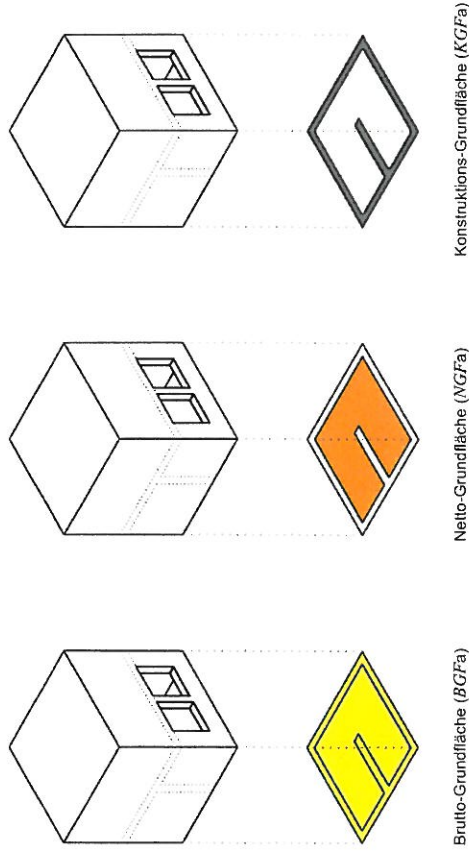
Geschossbezogene Grundflächen im Bereich a
